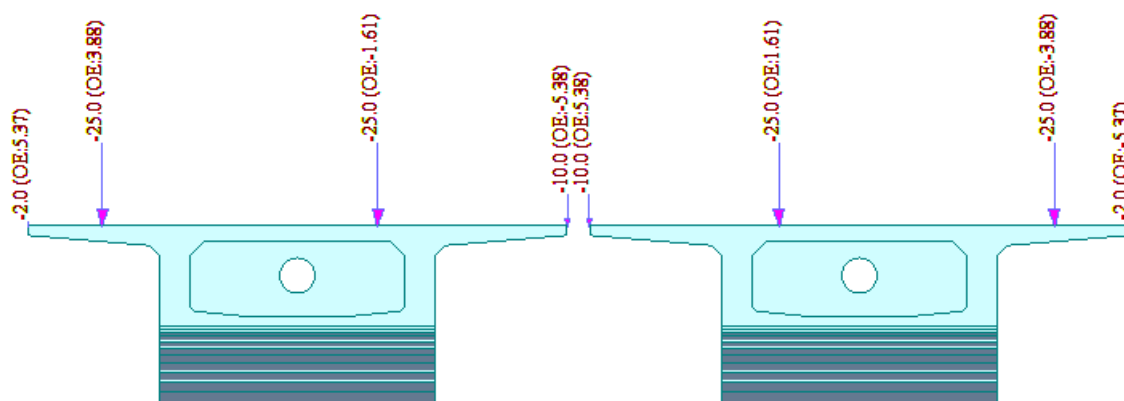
Disposizione dei carichi non strutturali lungo la sezione dell'impalcato
